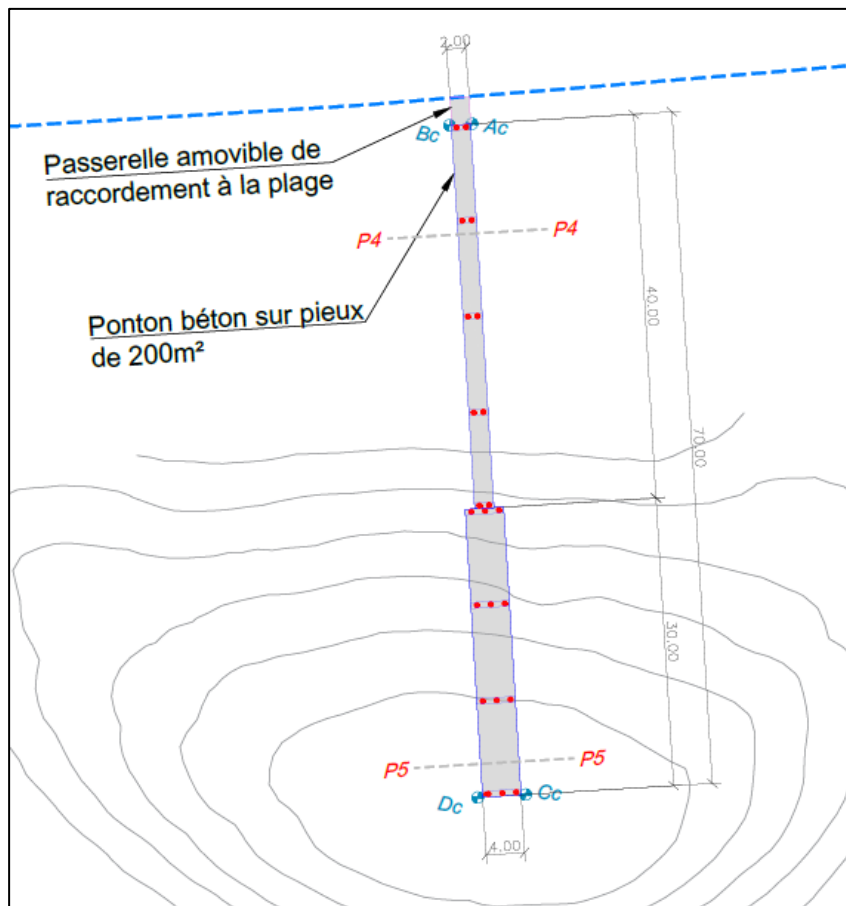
Nartelle centre – Aménagement appontement sur pieux – Vue en plan
